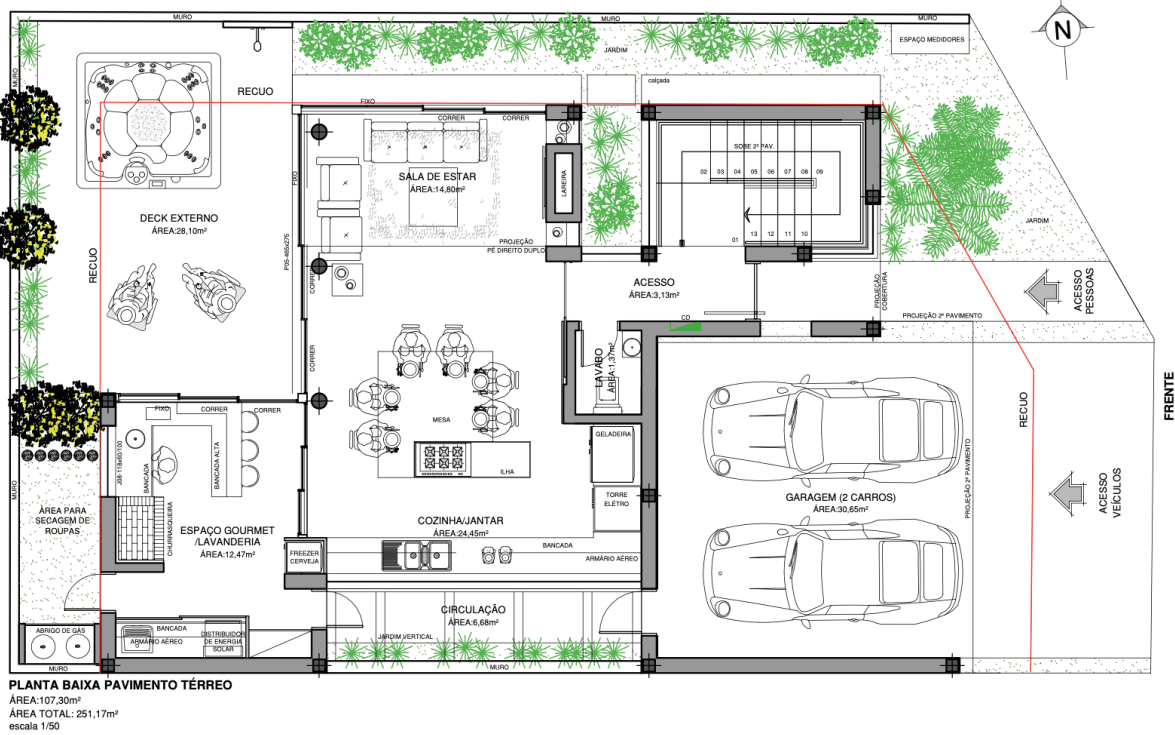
Planta baixa pavimento térreo. (Fonte: Projeto Arquitetônico)
